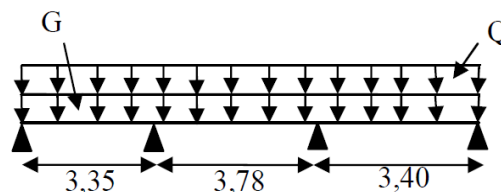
Schéma statique de la poutrelle T7 (plancher d'étage courant (1))
